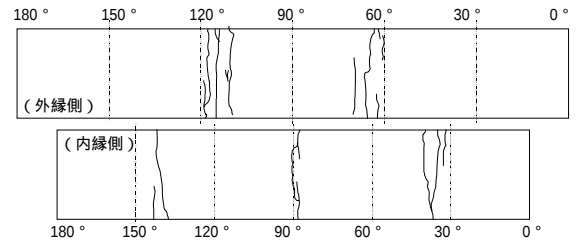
ひび割れ図 (, 天端変位 14.0mm)
